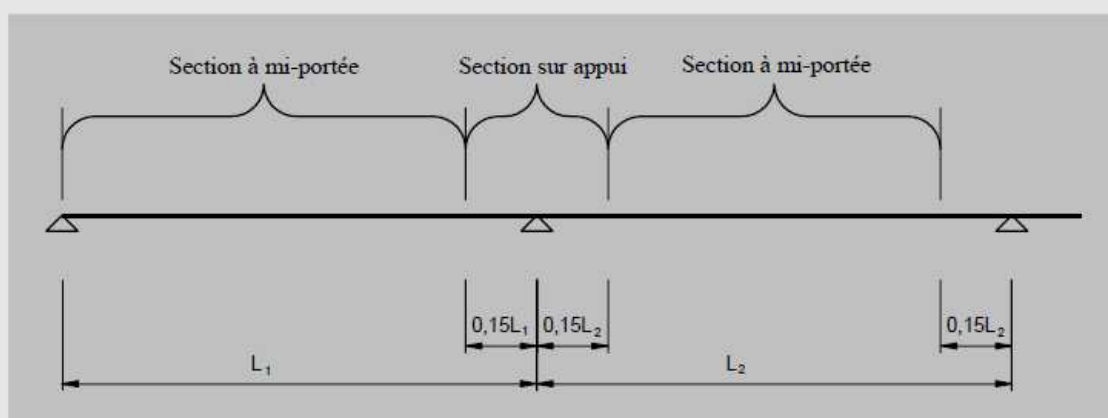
Zones où section à mi-portée ou section sur appui sont à considérer
